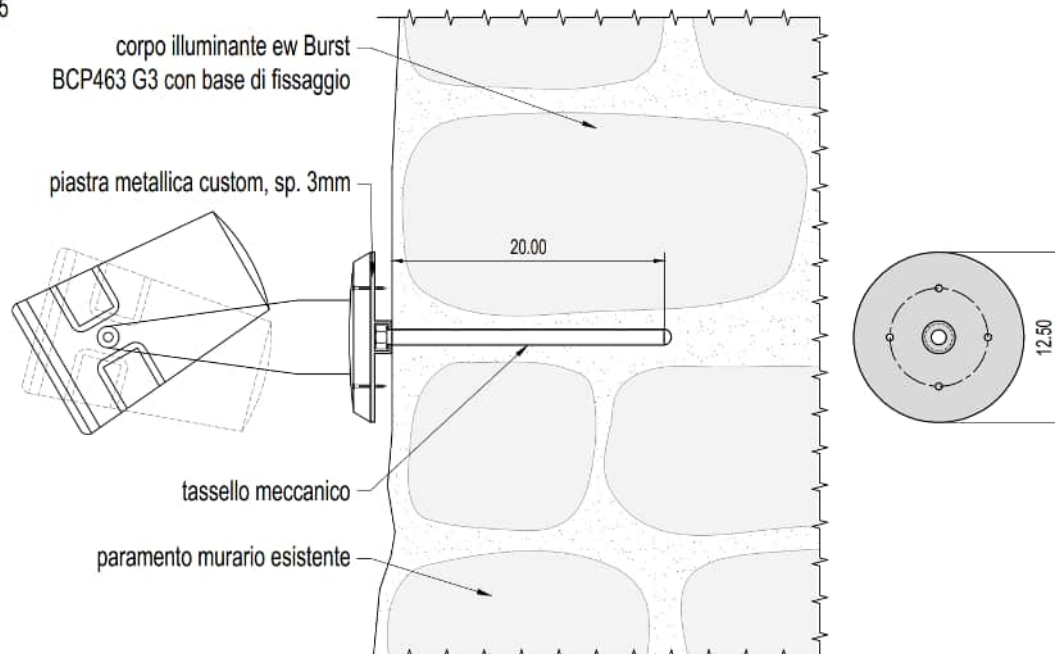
Progetto – Dettaglio ancoraggio corpi illuminanti su paramento verticale
